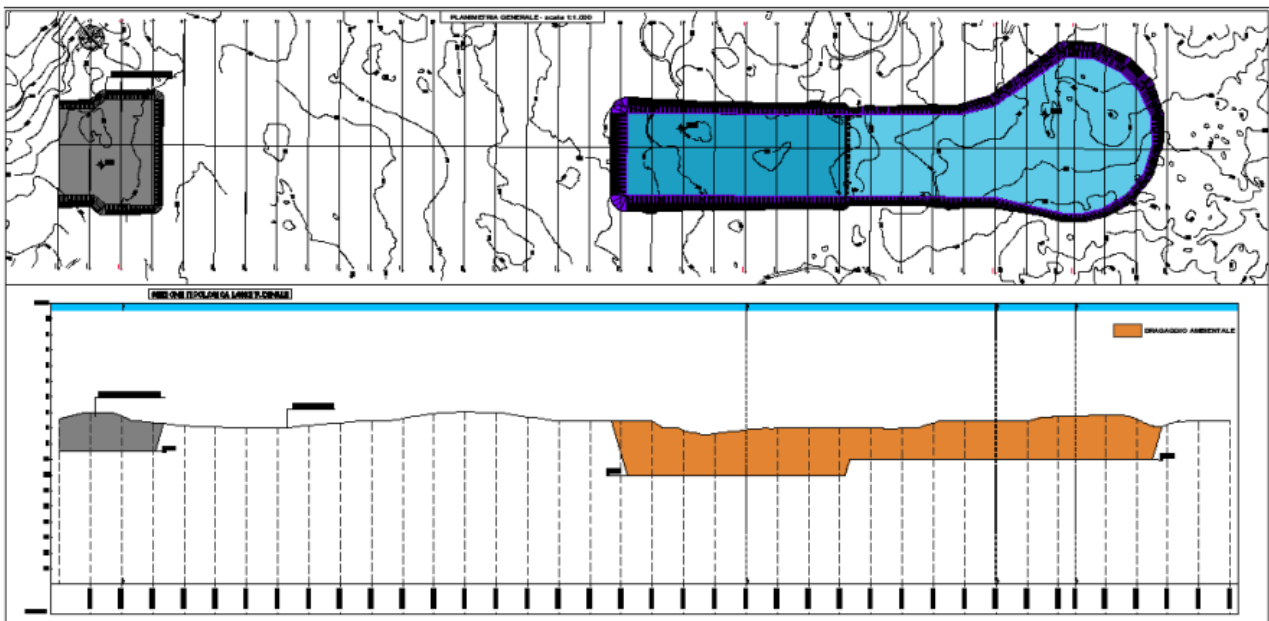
Planimetria e profilo longitudinale dei dragaggi ambientali
